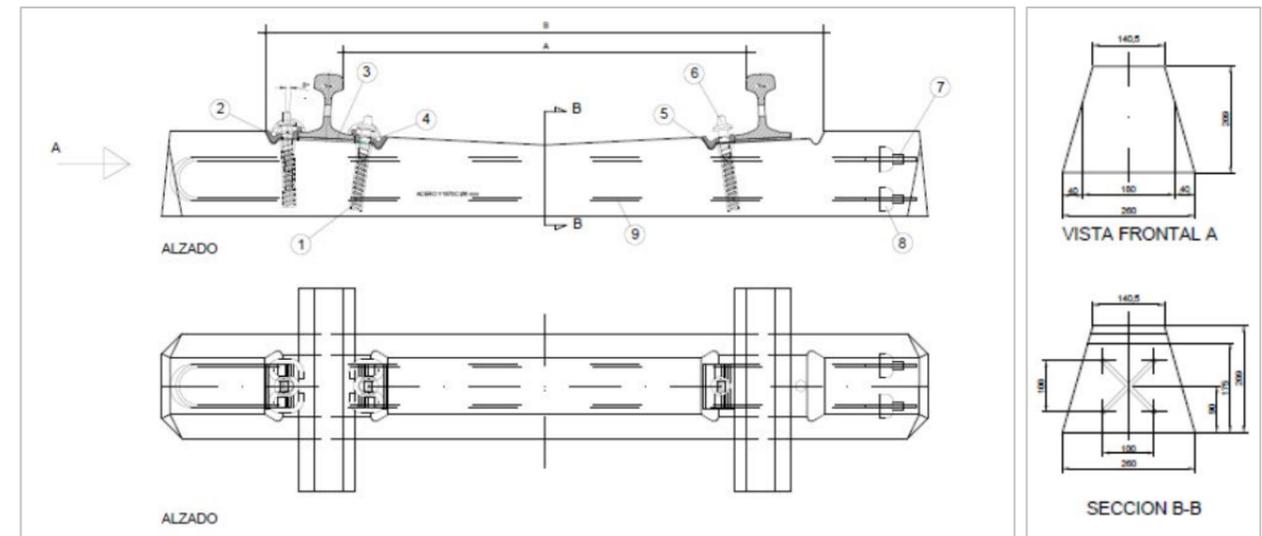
Travesía tipo DW con sujeciones y carril 54-E1. Fuente: [7]
